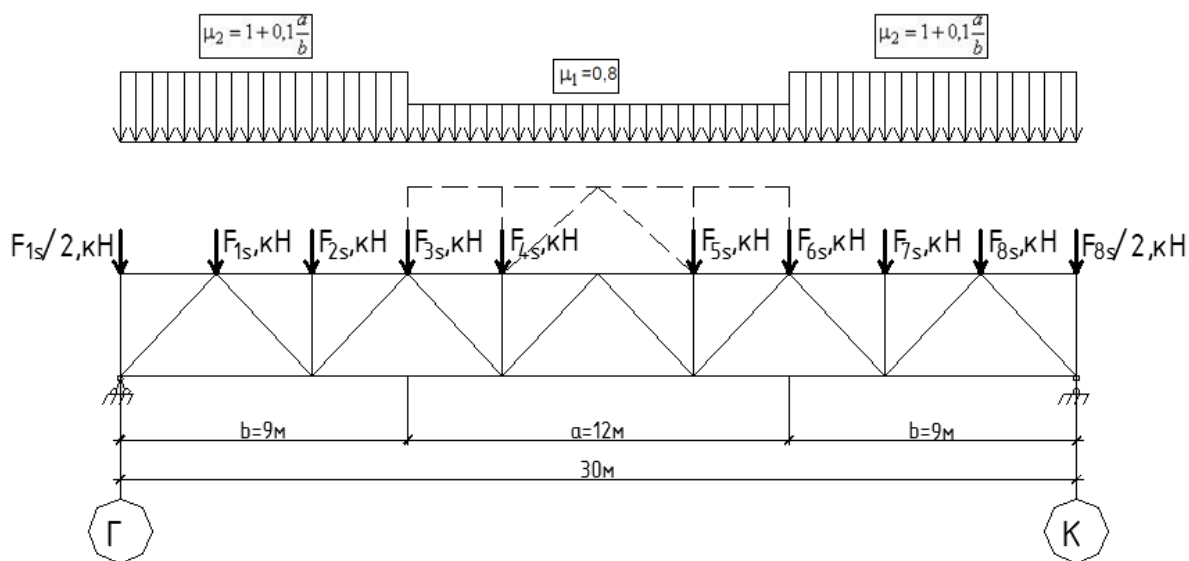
Схема снеговой нагрузки – вариант 1 для зоны С
